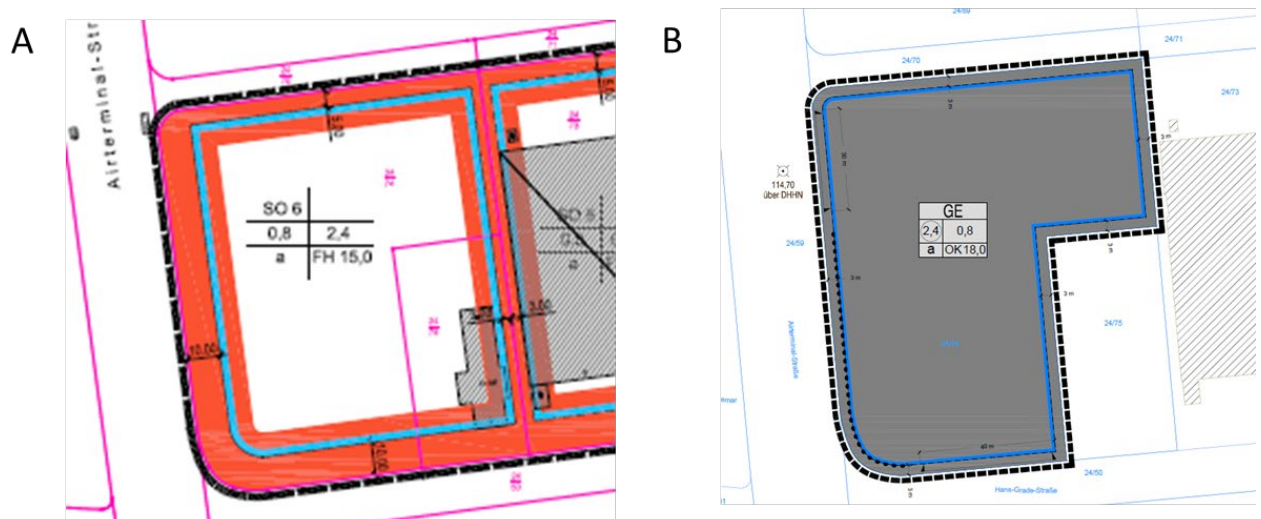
Plangebiet im alten B-Plan "Airterminal Nord" und im neuen B-Plan "Gewerbegebiet Airterminal-Straße/ Hans-Grade-Straße"
